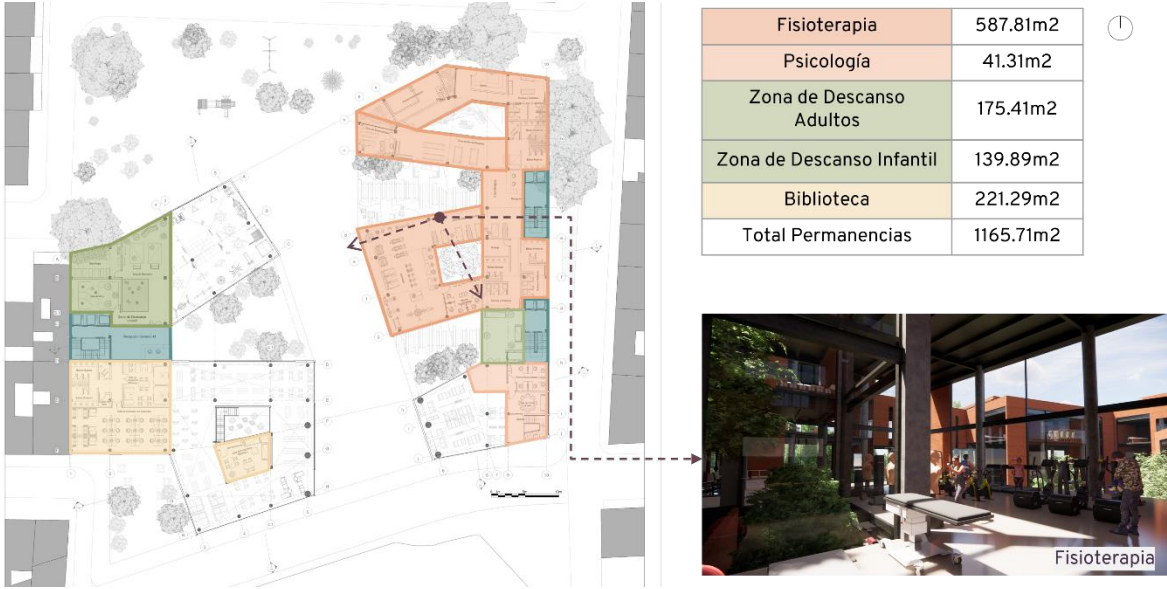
Planta de segundo nivel con actividad. Fuente: Elaboración propia
